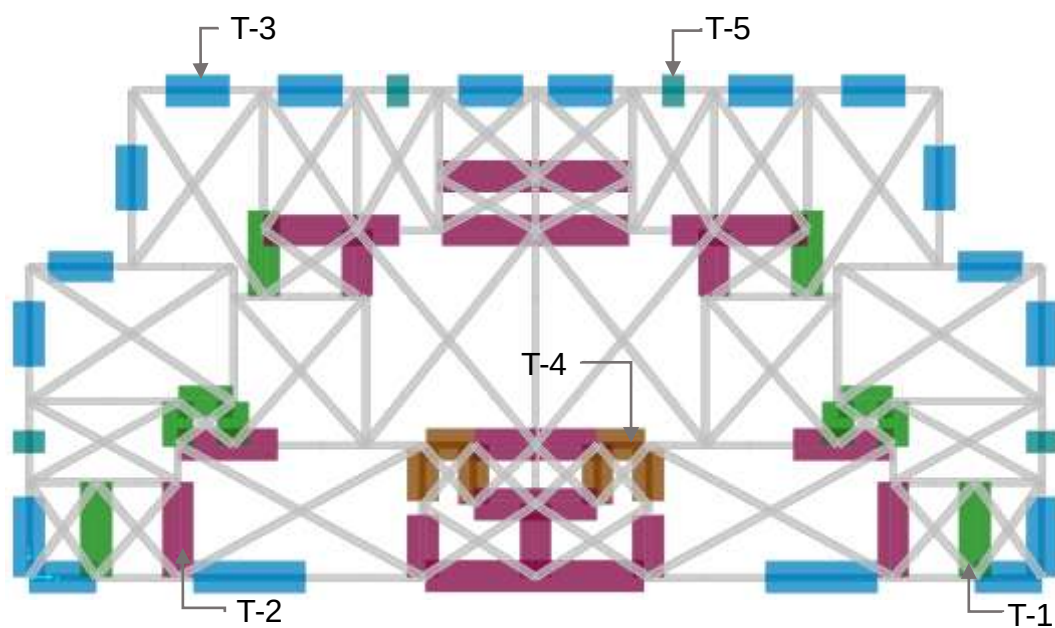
Planta a nivel de entrepiso del modelo de columna ancha.
